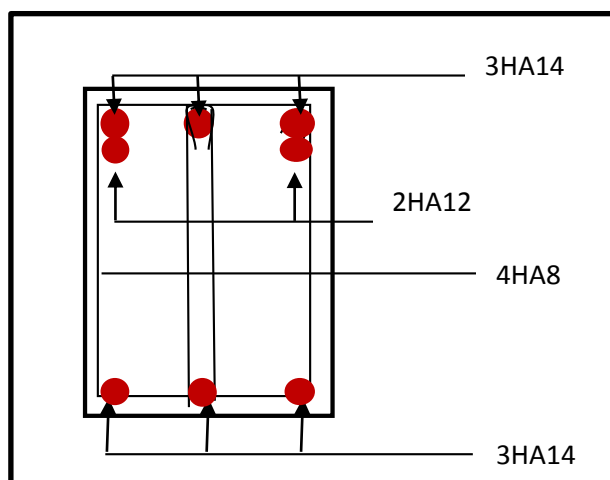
Ferrailage aux appuis d'une poutre secondaire.
